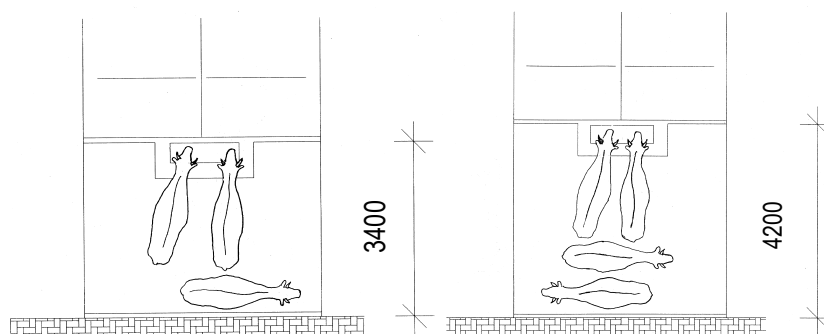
Umístění sloupu střešní konstrukce v boxu
